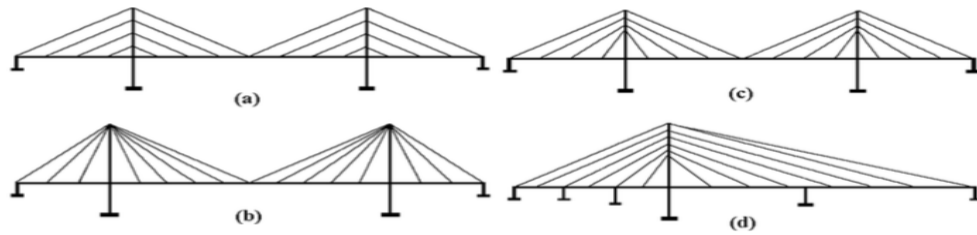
Esquema para un puente con estructura en doble voladizo.
